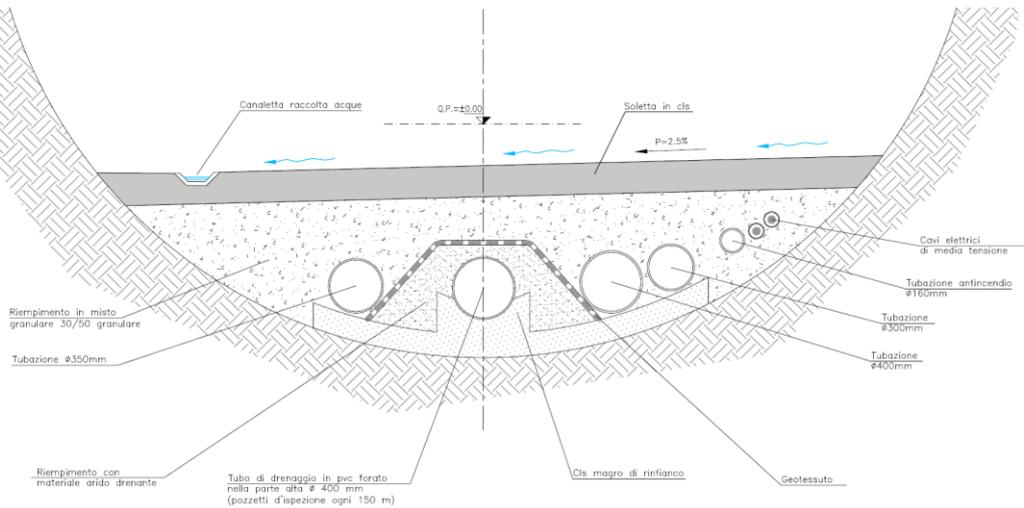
Canaletta per il drenaggio delle acque di piattaforma
